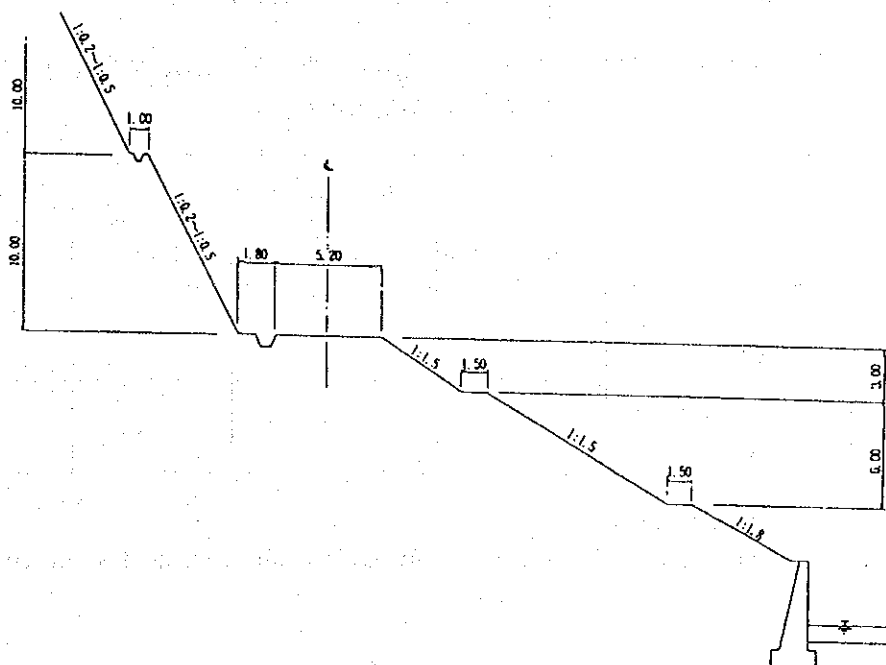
Sección Normal de Cortes y Terraplenes (Unidad : m)
